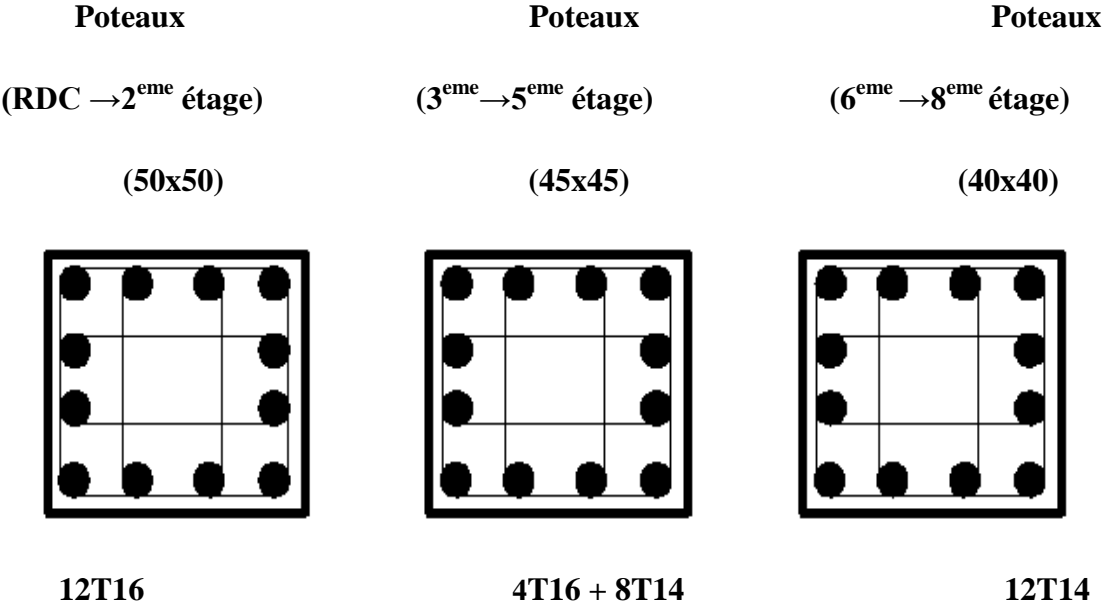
Dessin de ferrillages des sections des poteaux
